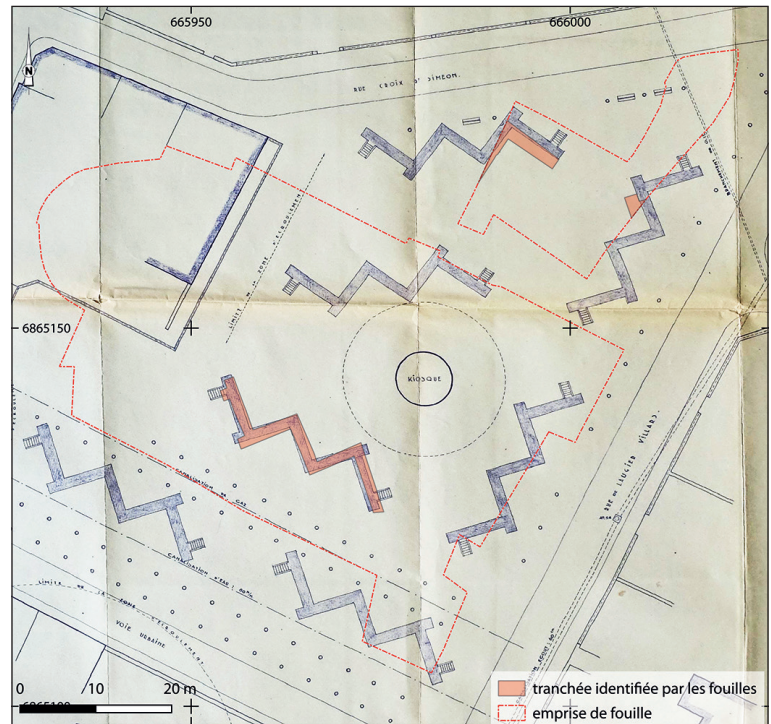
Superposition des vestiges archéologiques de la Seconde guerre mondiale sur le plan du projet de tranchées-abris de la place Foch à Gagny, 1942, Arch. mun. Gagny, boîte 1, O. Bauchet, Inrap.
